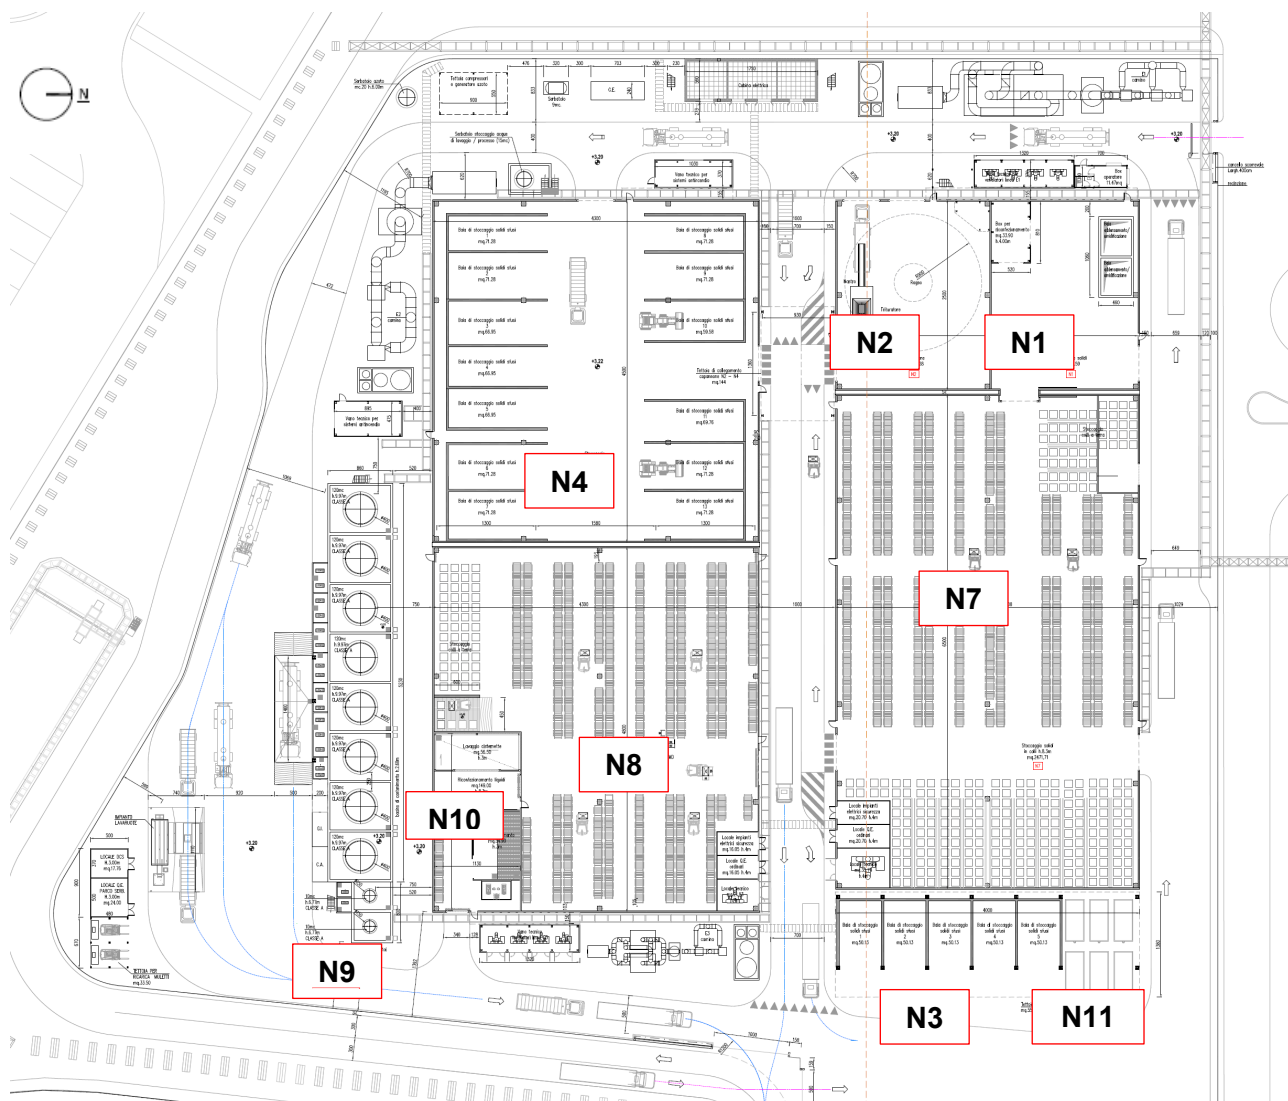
Stralcio della planimetria generale (CO 05 RA VA 01 D1 PL 49.00 - LAYOUT GENERALE PIATTAFORMA). Dettaglio sezioni in progetto.
